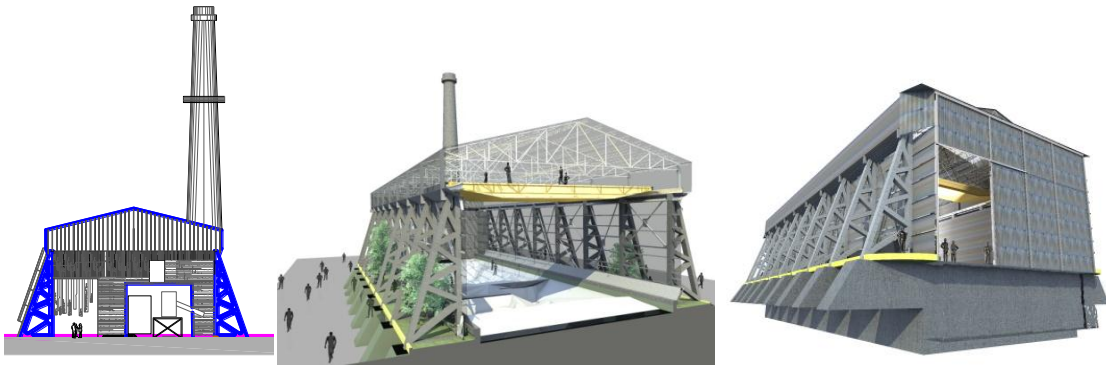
Levantamiento en CAD. Fig.59 y 60. Levantamiento estructural 3D y formal 3D)
